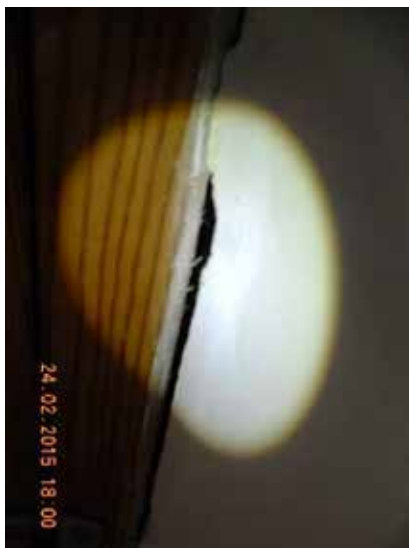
Misma grieta que la fachada que ha atravesado el muro.
